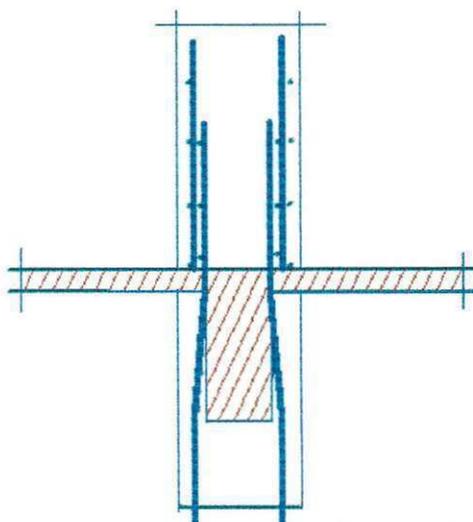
Ferro de espera dos pilares dobrados para o interior da continuidade do pilar.
